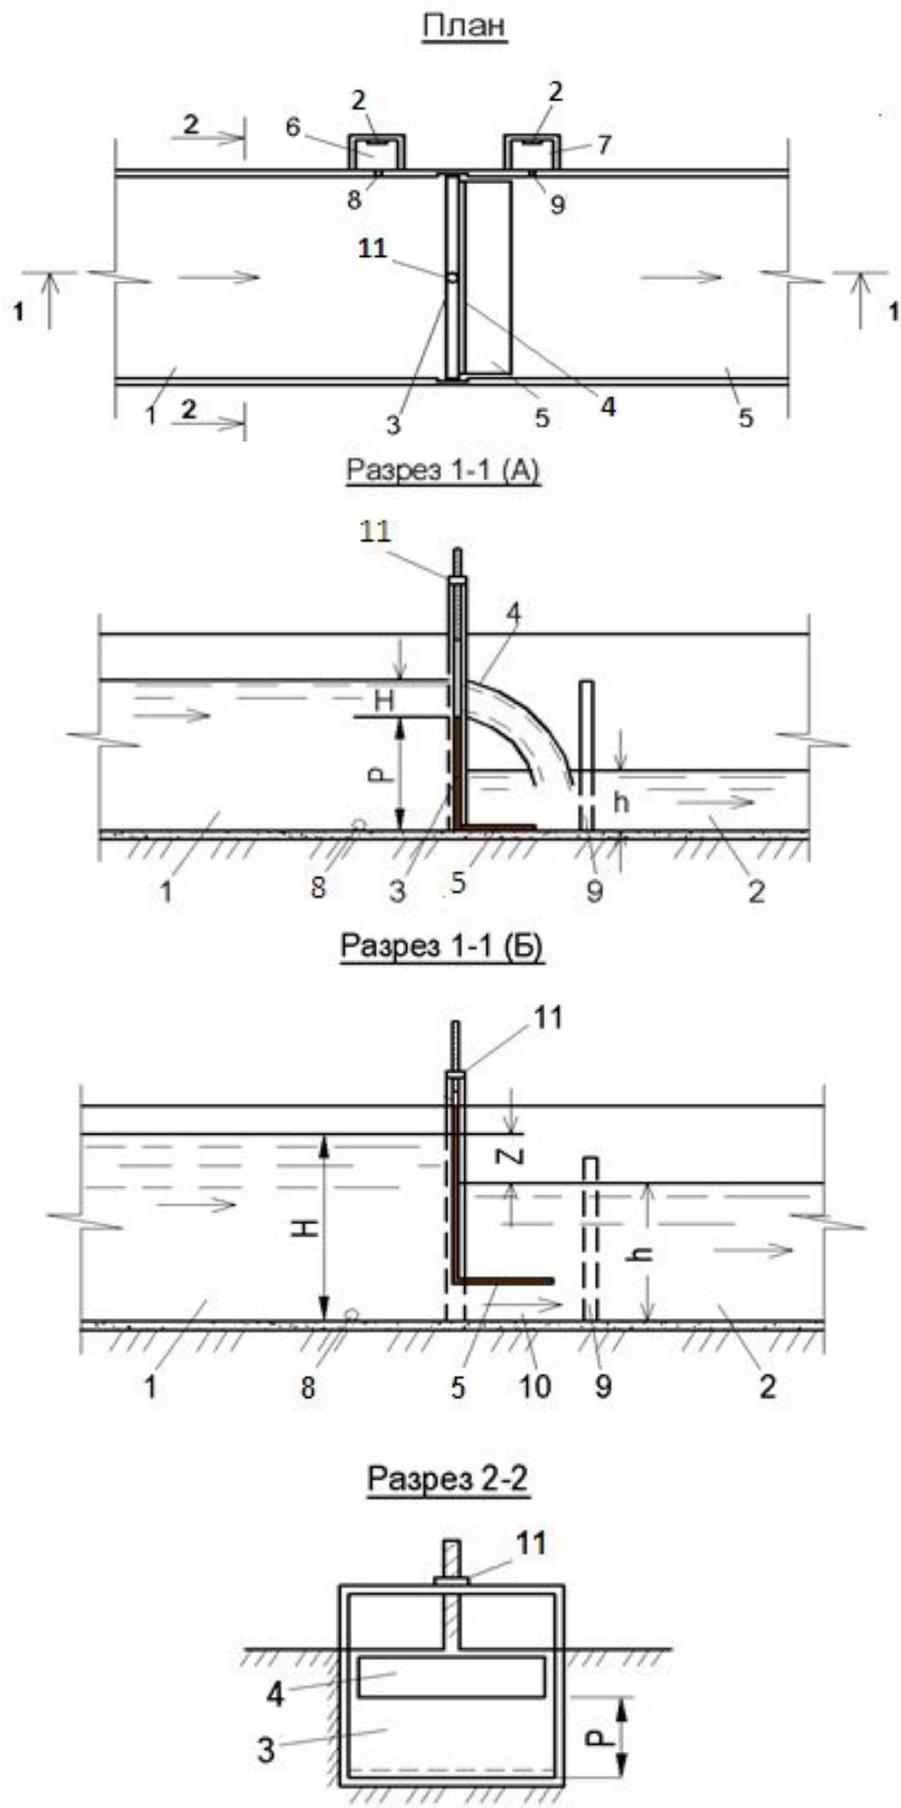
Схема комбинированного водомера типа «Водослив-насадок» применительно к водотокам прямоугольного сечения
